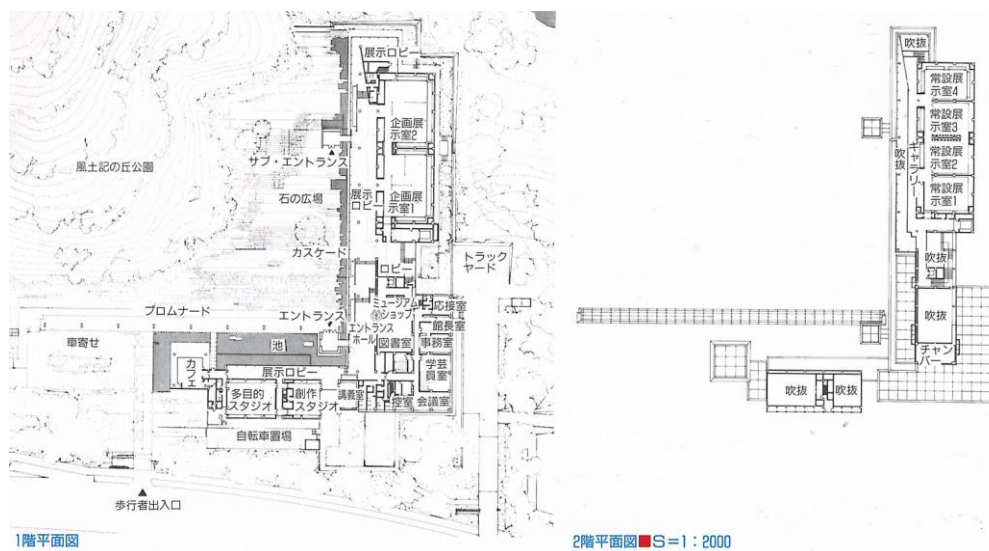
郡山市立美術館 1階平面図、2階平面図
